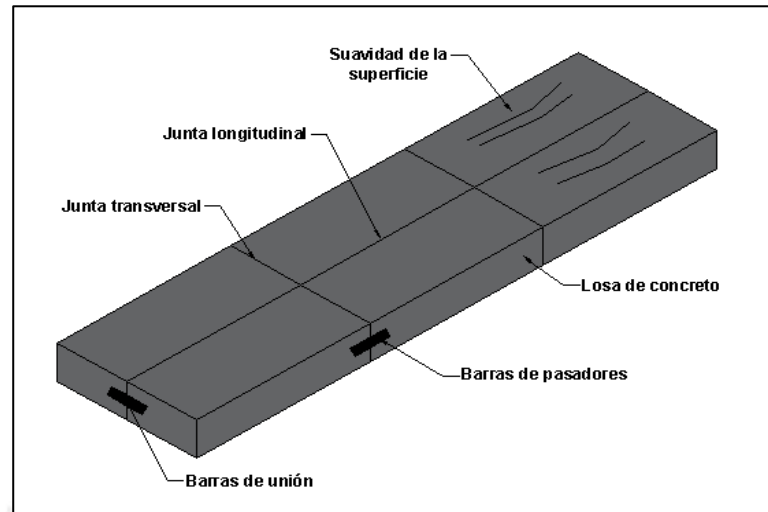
Vista típica de pavimento articulado de concreto simple (JPCP).
